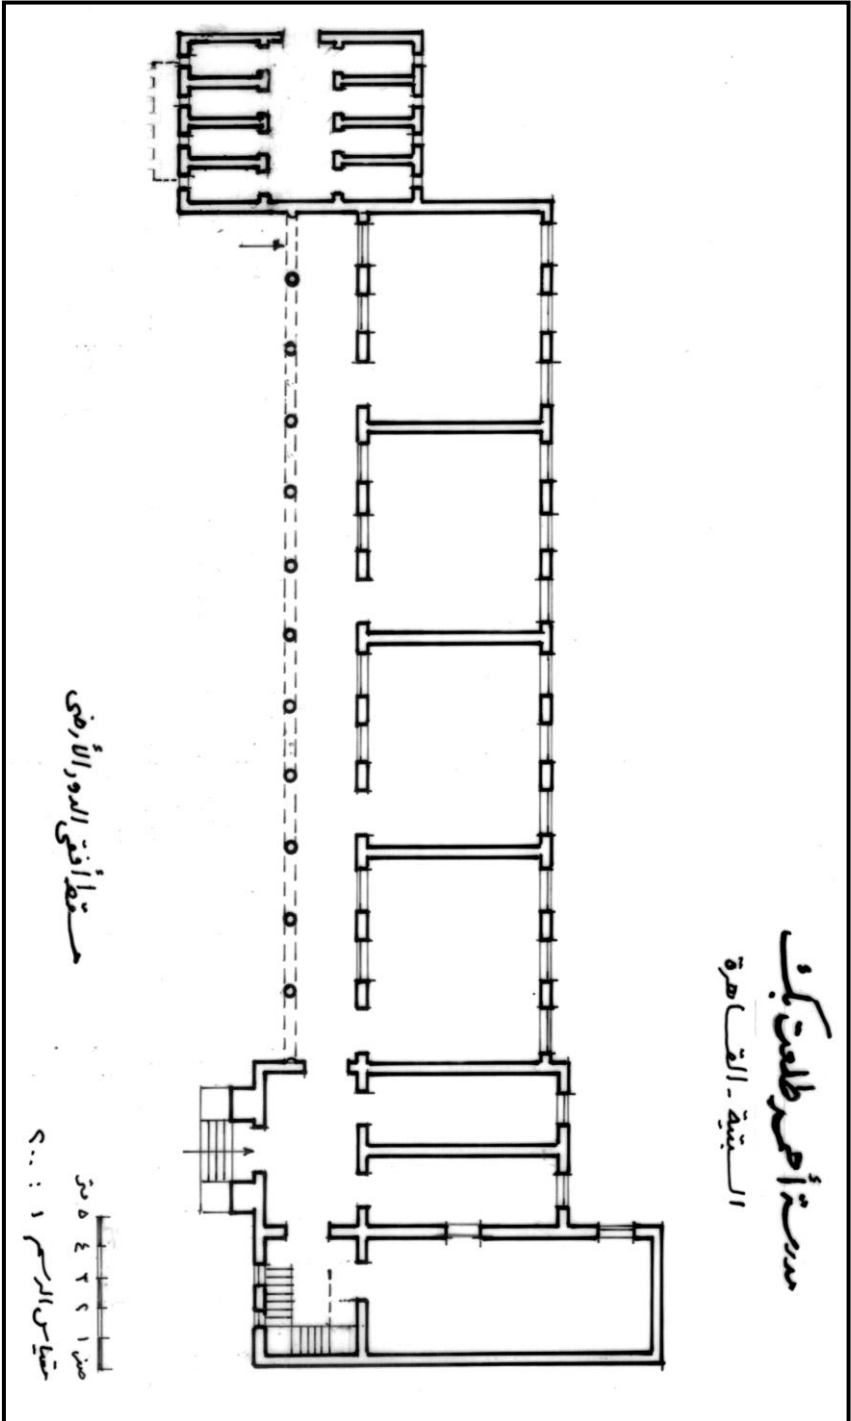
مسقط أفقي لمجمع أحمد طلعت بك من خلال ما ورد بحجة الوقف
